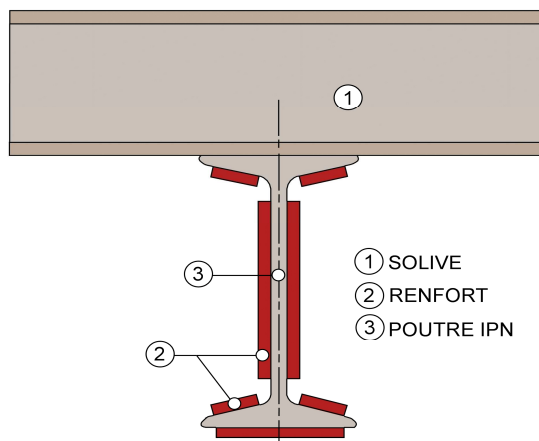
Ajout de plats soudés, semelles et âmes.
